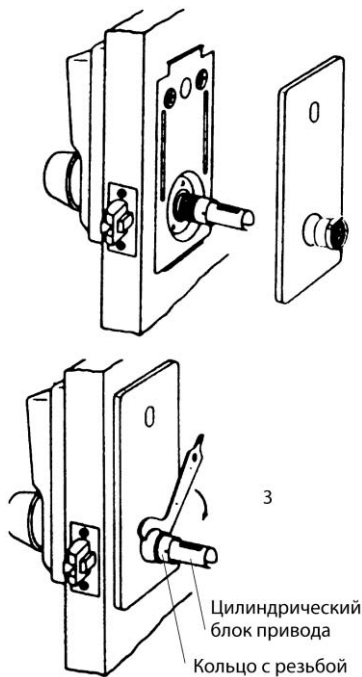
Установка внутренней декоративной накладки: 1 — цилиндрический блок привода; 2 — кольцо с резьбой (С разрешения компании Simplex Access Controls Corp.)
